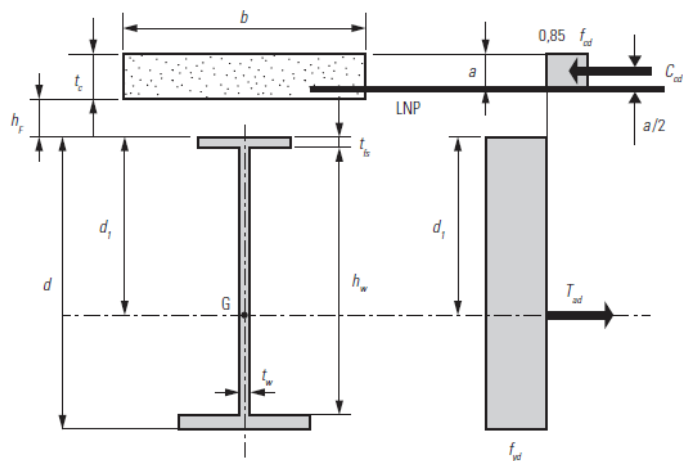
Distribuição de tensões nas vigas mistas, linha neutra plástica na mesa de concreto, (FACKURY, 2016)
